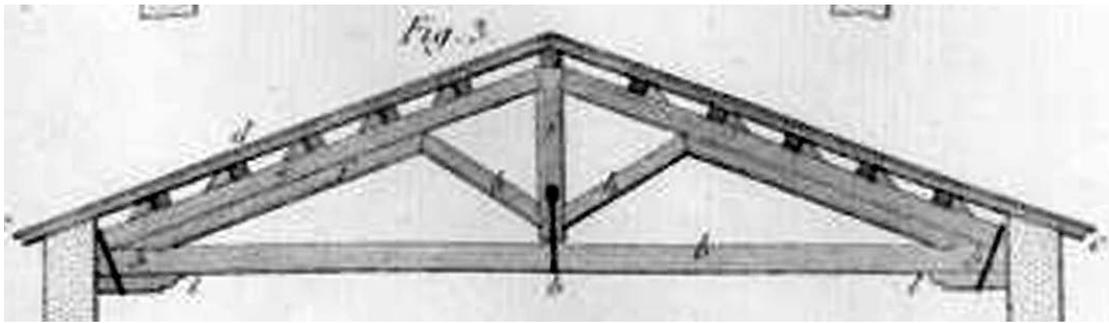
Dachwerk der Kirche Santa Sabina in Rom<sup>47</sup>
